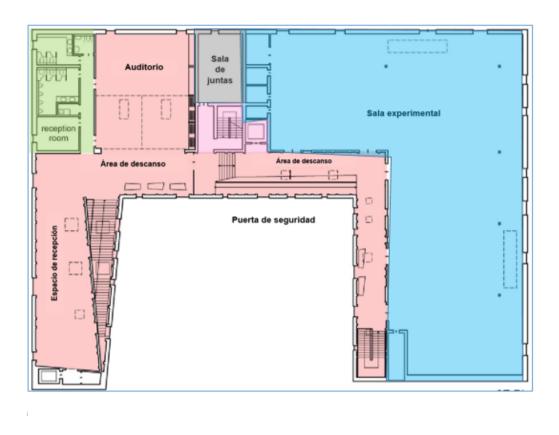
Planta 2do Nivel, SPIRALAB
